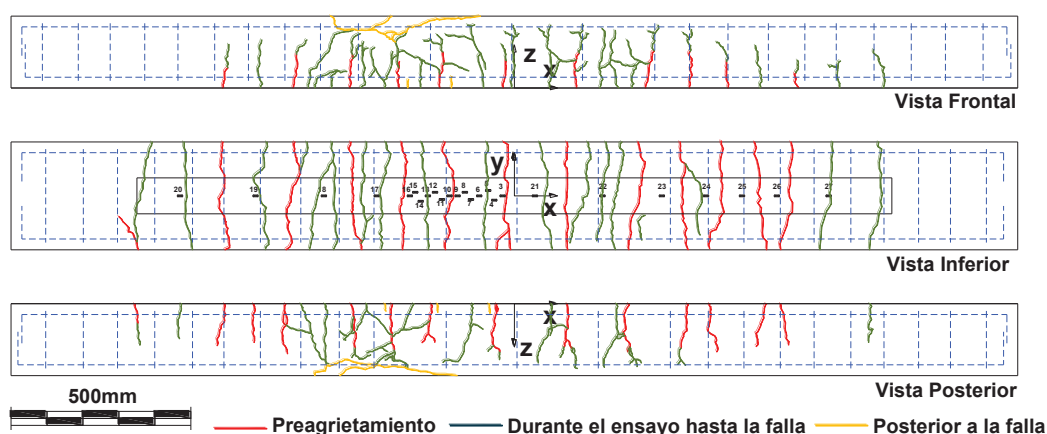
Esquema del patrón de agrietamiento de la viga 2A durante el ensayo por carga última.
